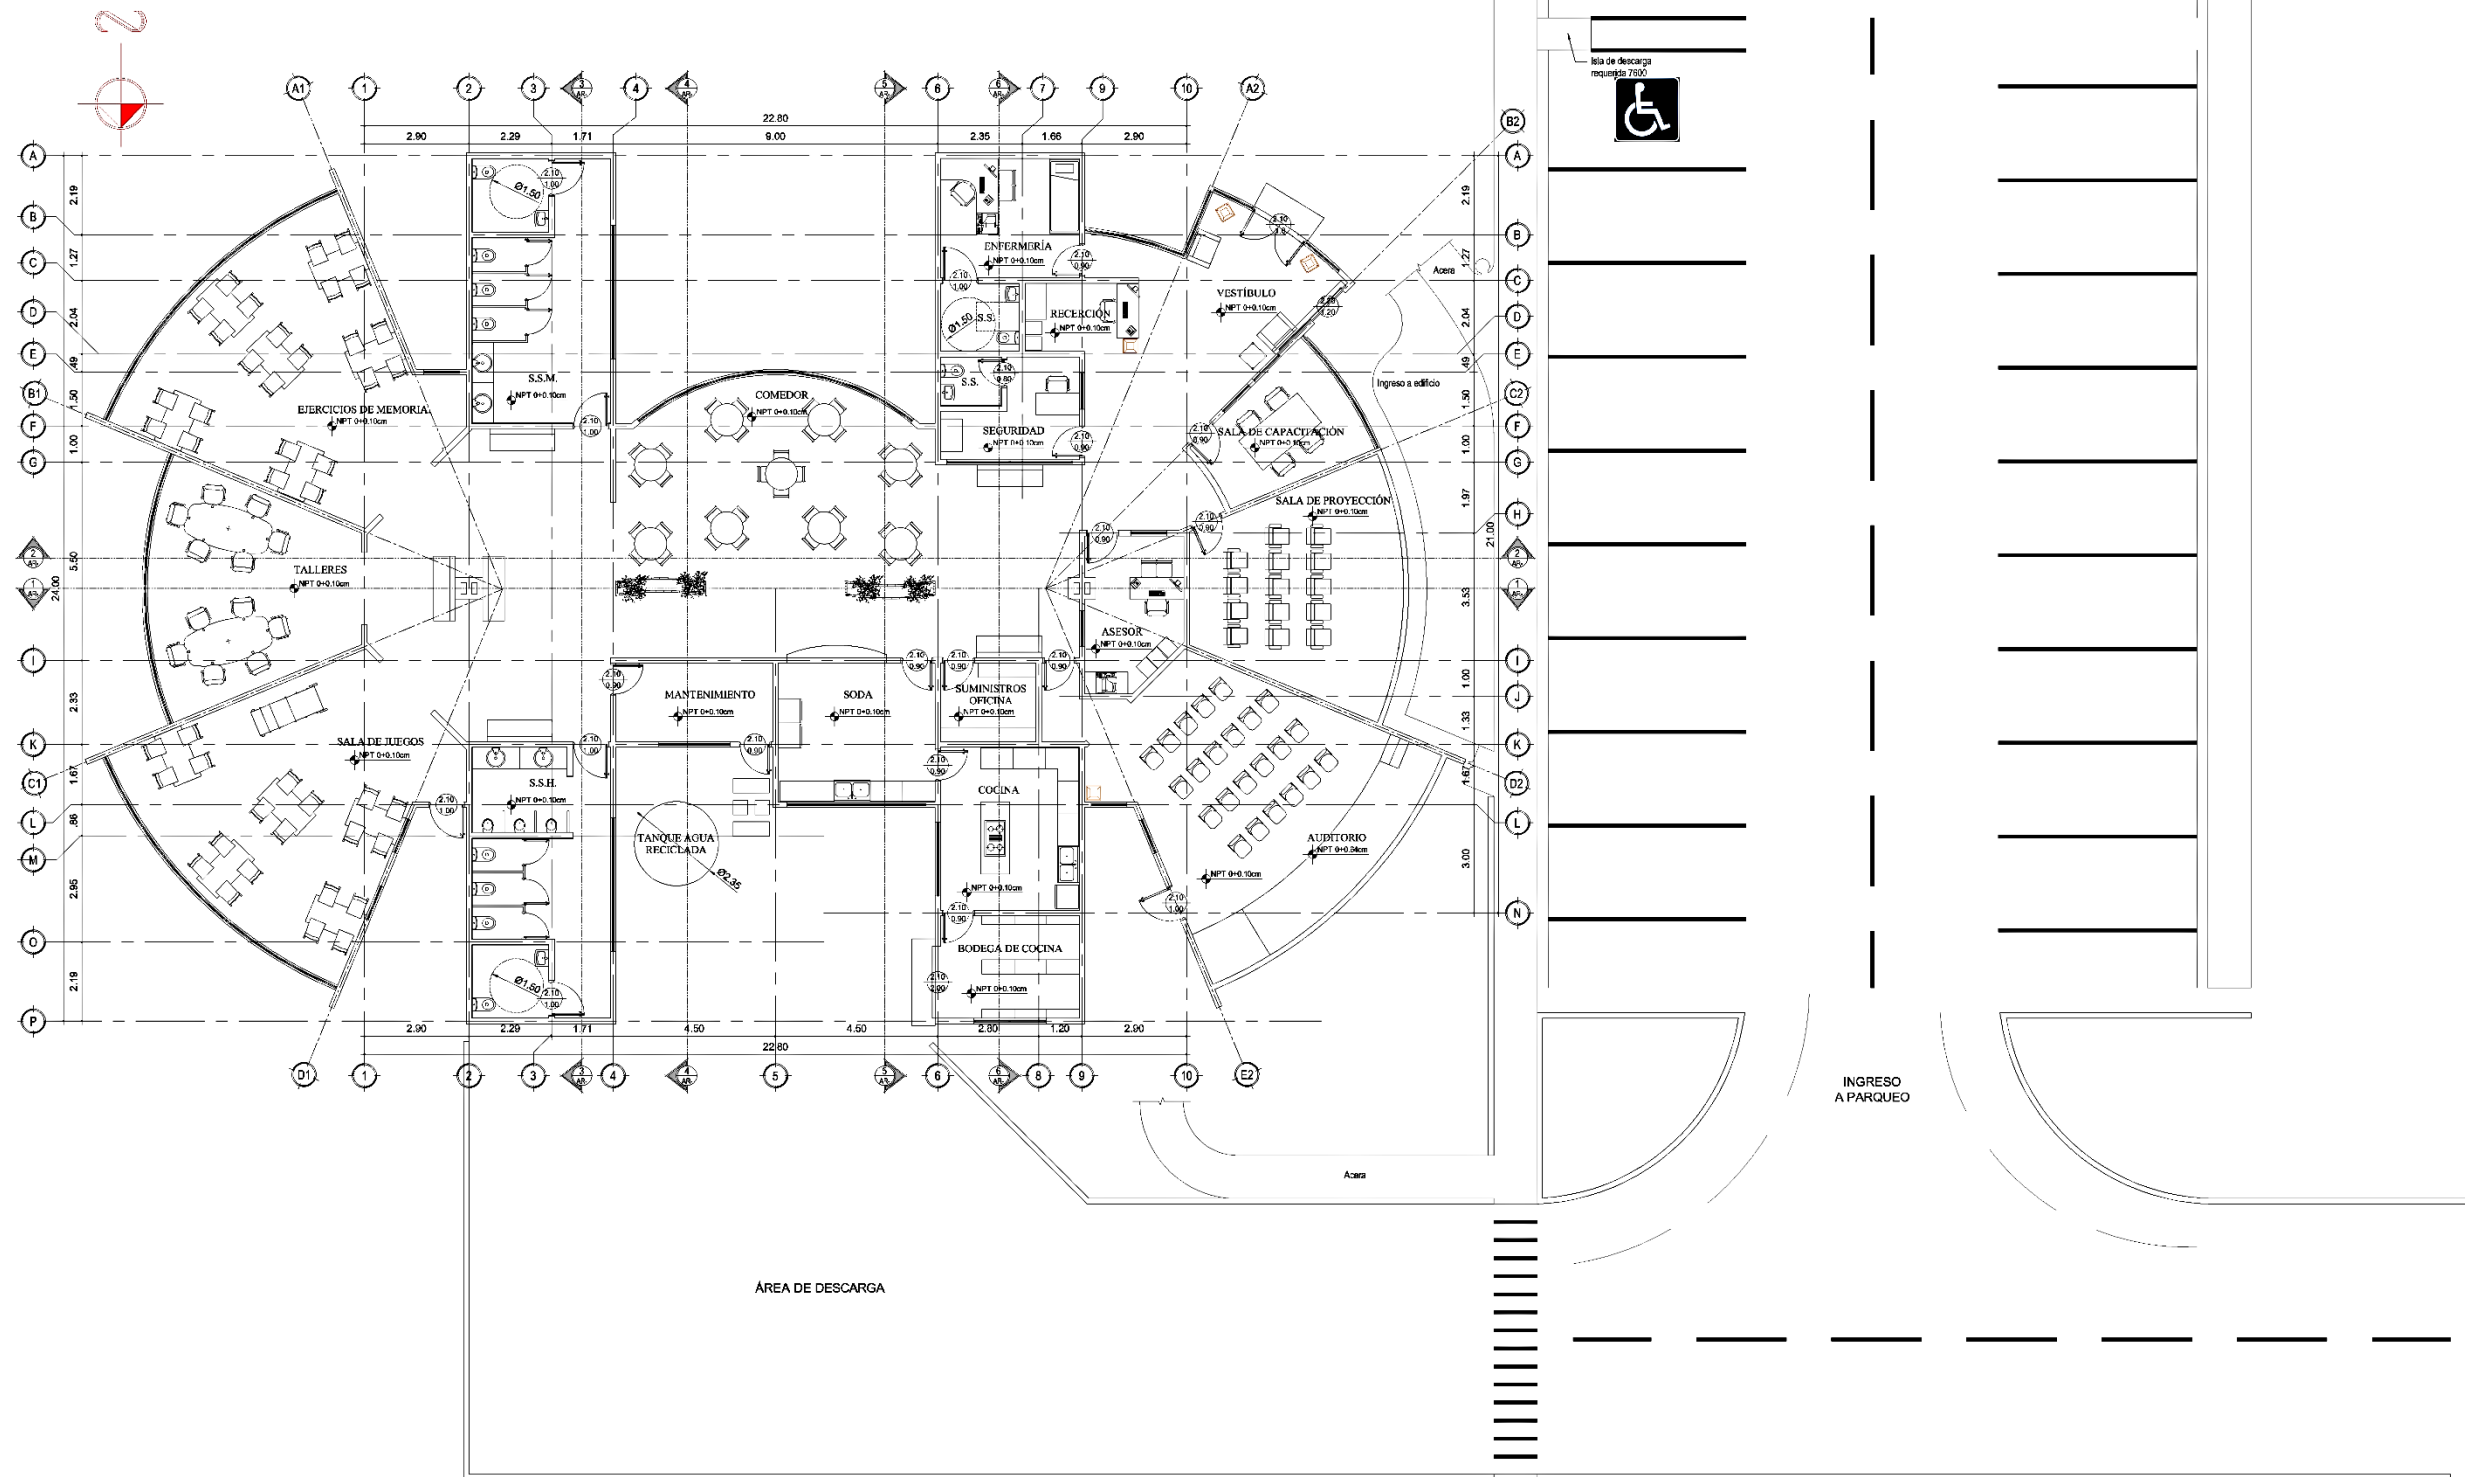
Planta de distribución arquitectónica. Fuente: elaboración propia.
